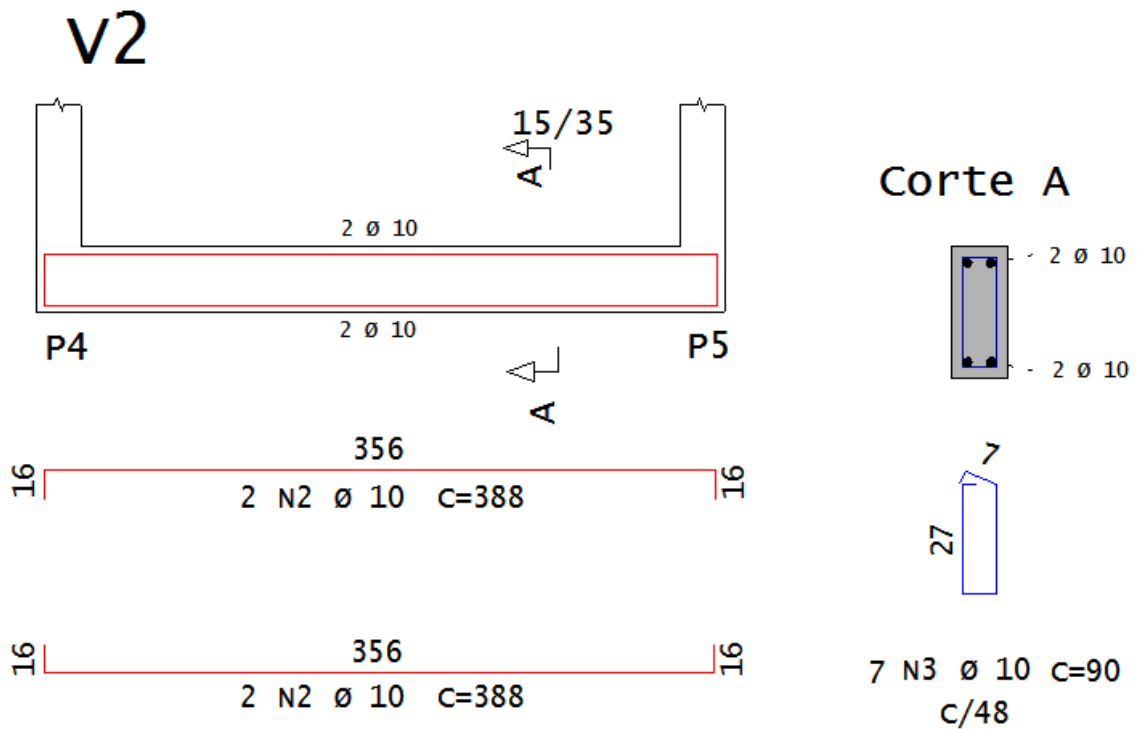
Detalhamento das armaduras na seção da viga 2 com base no ACI 318 (2014)
